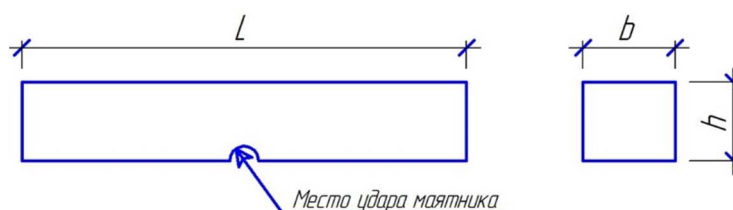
Схема испытания керамзитобетона на ударную вязкость
